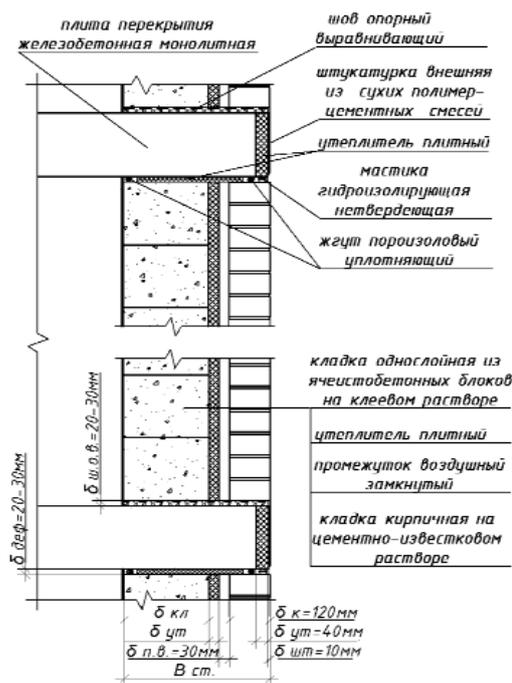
Стена трехслойная из ячеистобетонных блоков и плитного утеплителя с обкладкой лицевым кирпичом
